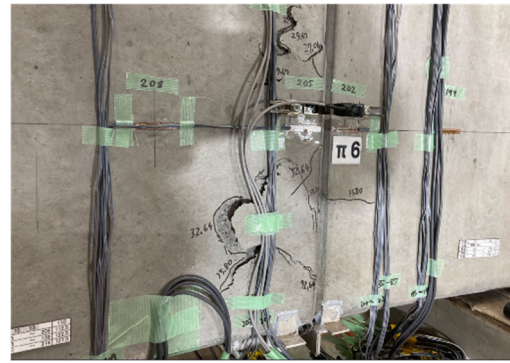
110° 付近内面の破壊状況 (第1ピーク後)
